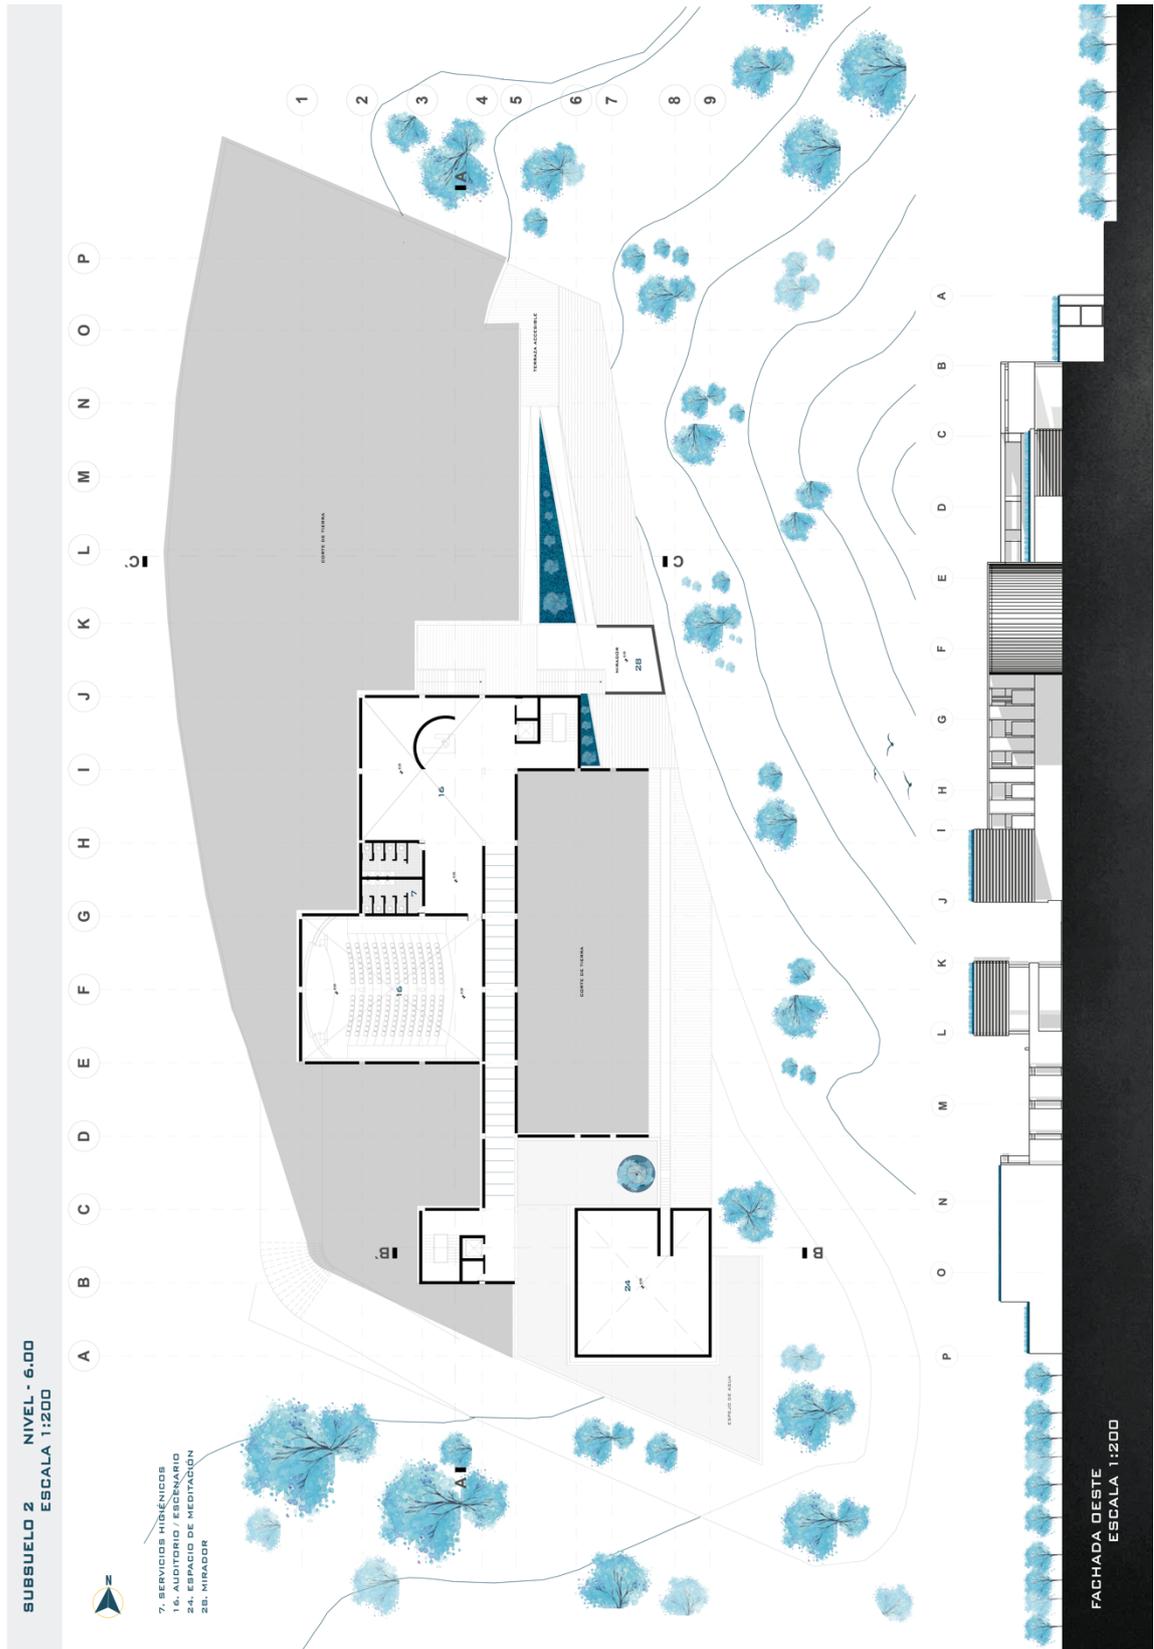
Subsuelo 2 / Fachada Oeste. (Elemento Propio)
